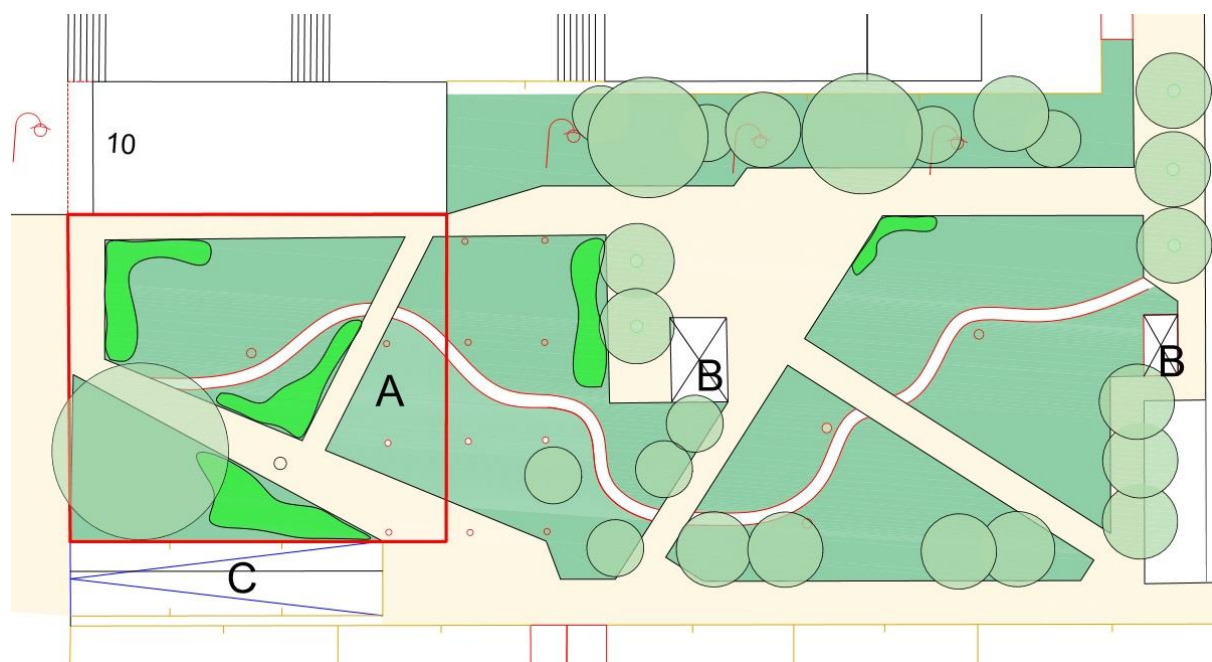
Proposta: Planta Geral Rua Teixeira de Pascoais.
